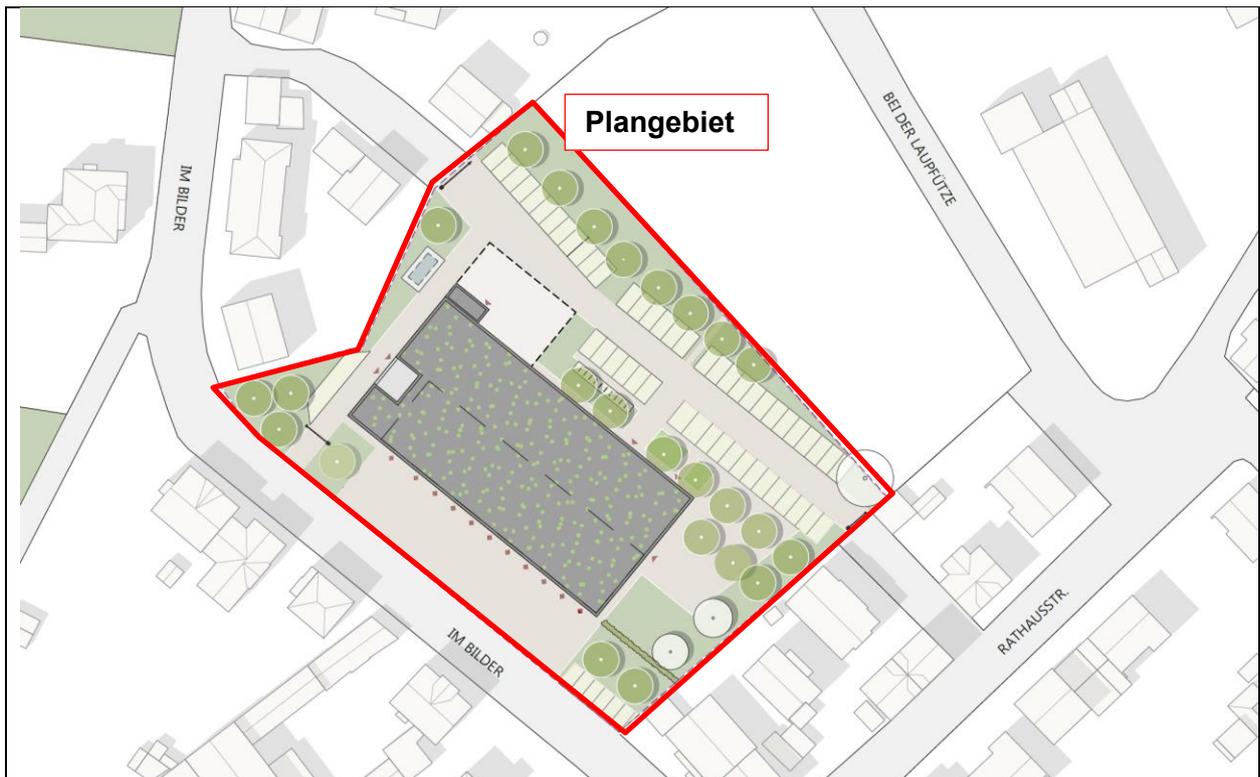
Grundrissplan Feuerwehrrätehaus Bebra (unmaßstäblich)
